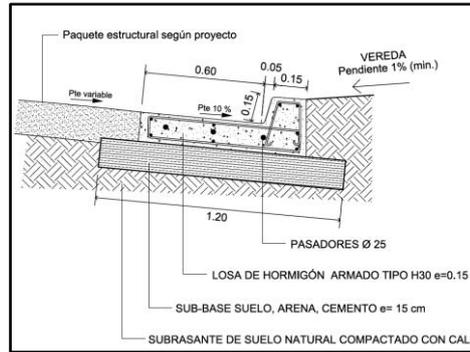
Detalle constructivo de cordón cuneta de hormigón armado.
